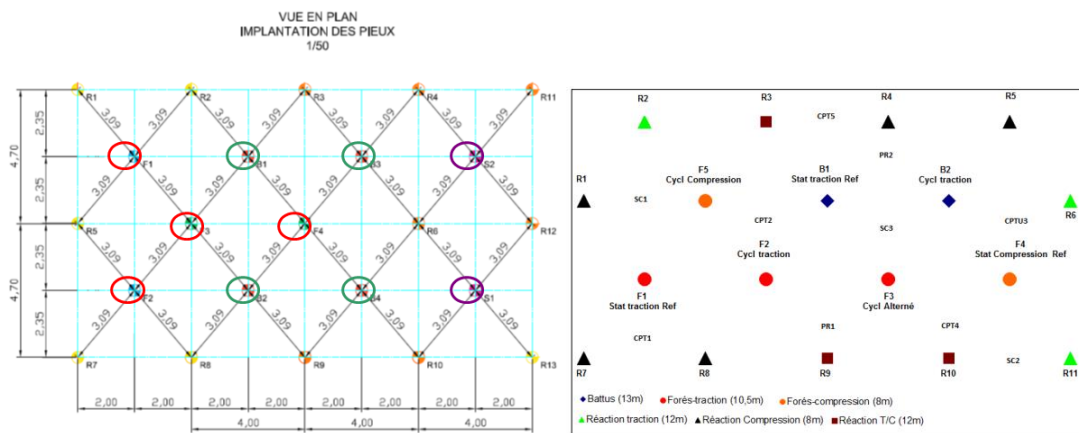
Plan d'implantation des pieux, (a) chantier de Merville : rond rouge Pieu foré, rond violet : pieu vissé, rond vert : pieu battu et (b) chantier de Loon Plage (Benzaria, 2013).
